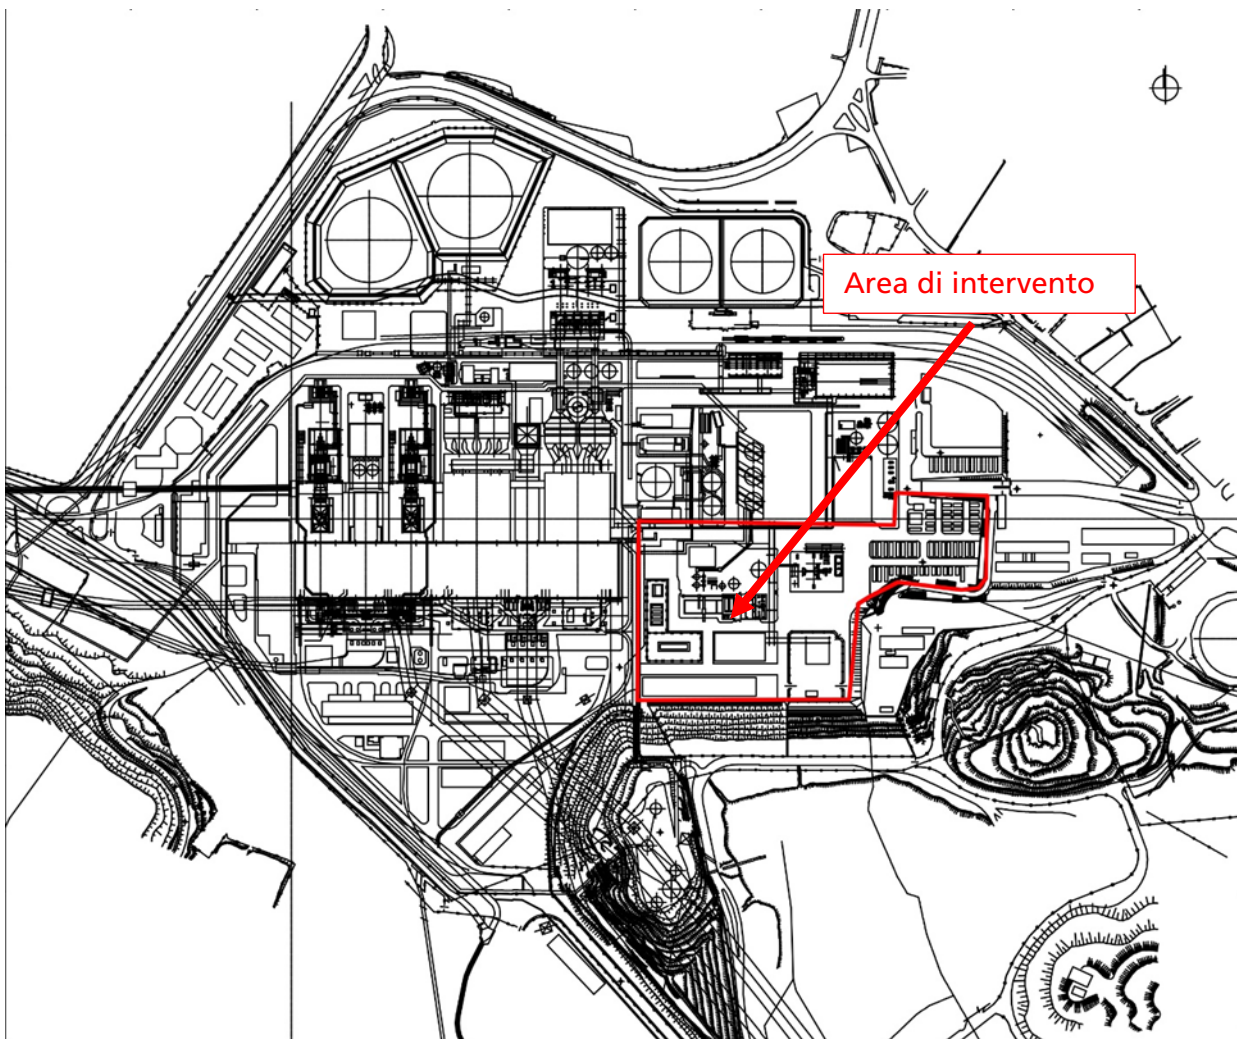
Planimetria dello stato attuale con indicata l'area di intervento
